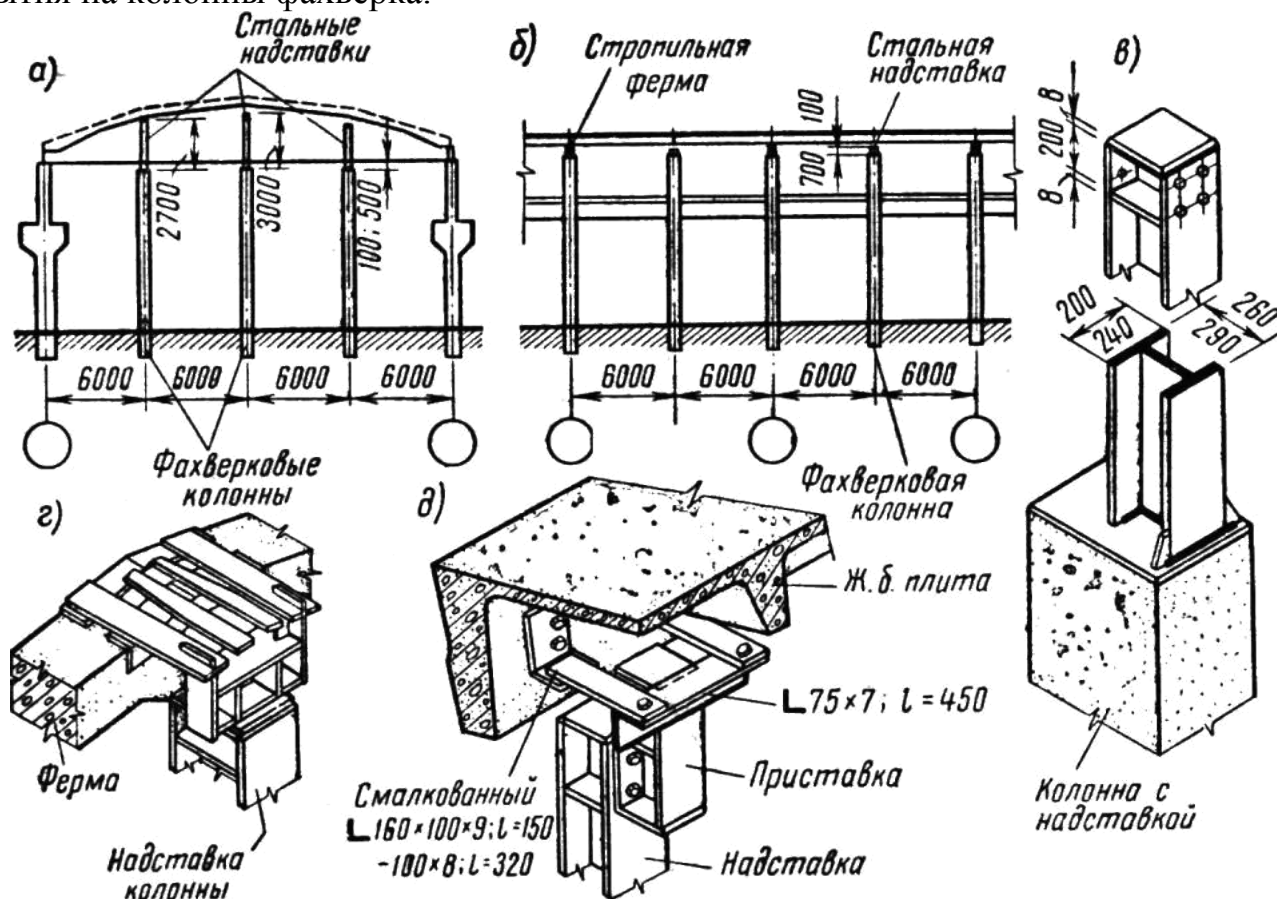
Фахверковые колонны: —схема торцового фахверка; б — то же, продольного; в — стальная надставка фахверковой колонны; г — крепление торцевой колонны к ферме покрытия; д — крепление продольной колонны к плите покрытия
